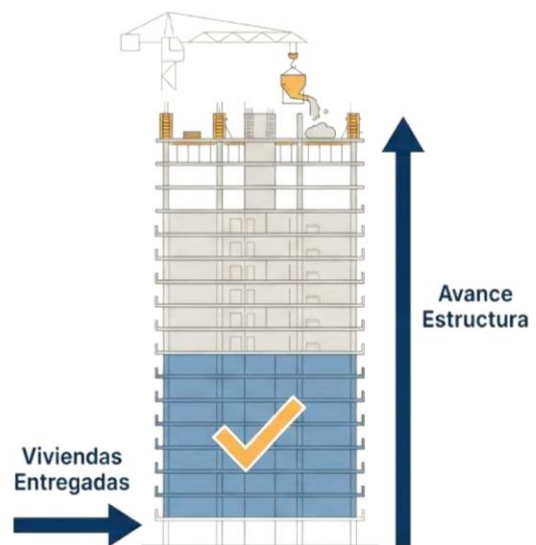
Planificación TM Tower. Viviendas entregadas y estructura en ejecución
